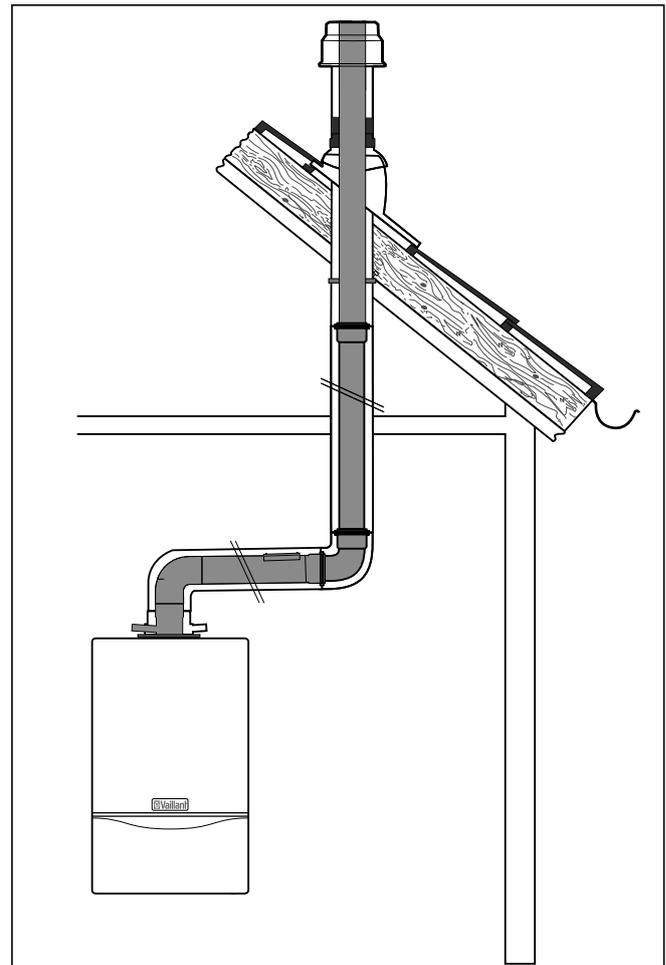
Montagebeispiel: Senkrechte Dachdurchführung
